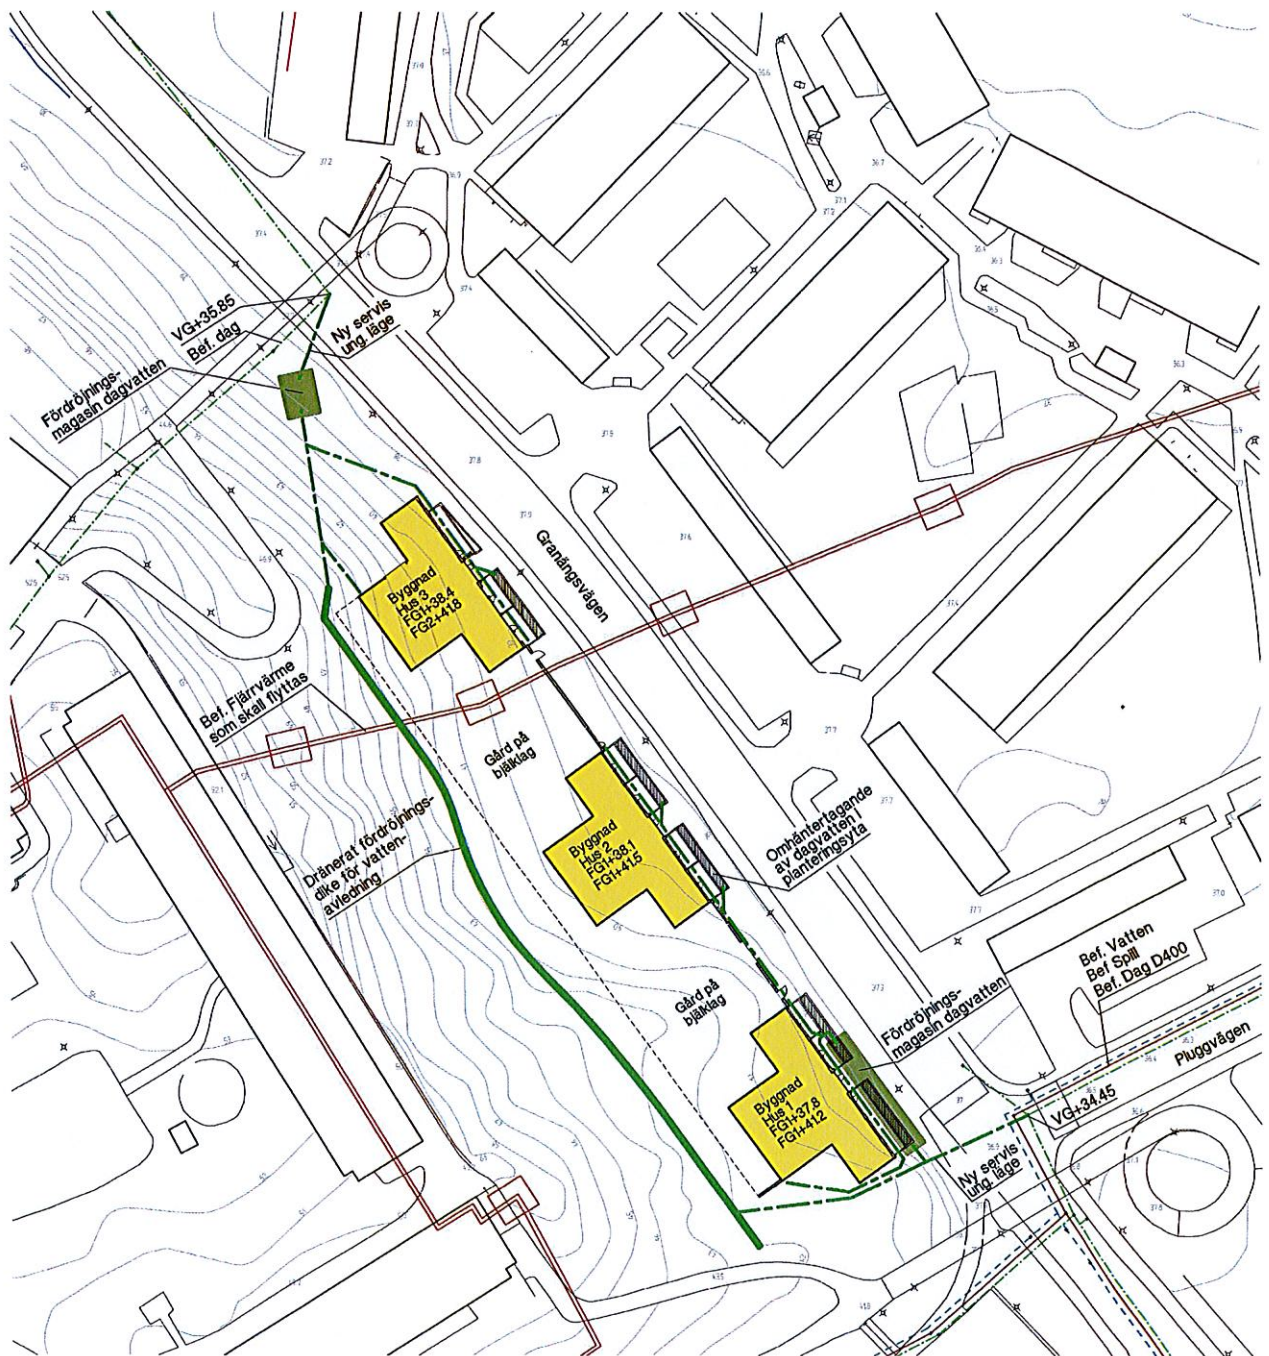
Planerad bebyggelse, bef. ledningar samt placering av fördröjningsmagasin och dränerat fördröjningsdike
